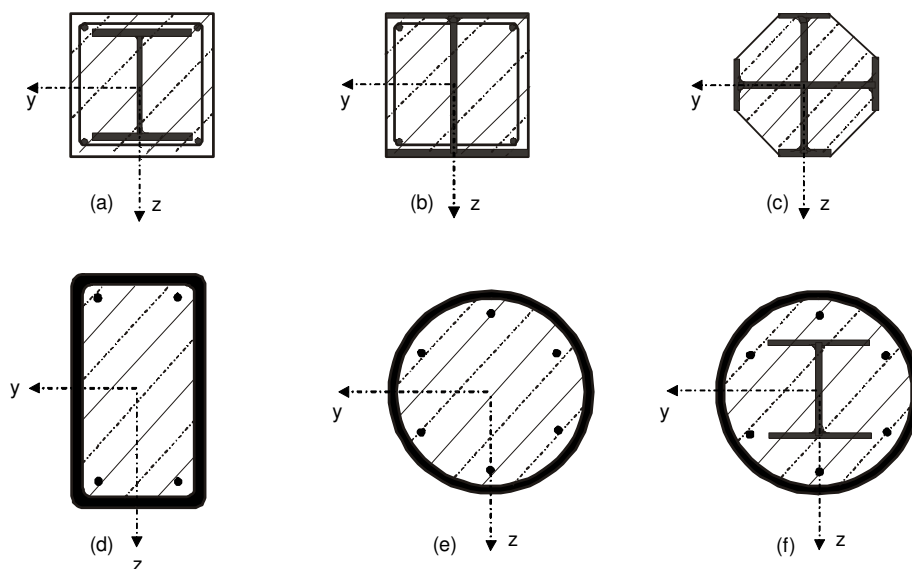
Seções transversais típicas para os pilares mistos de aço e concreto.
